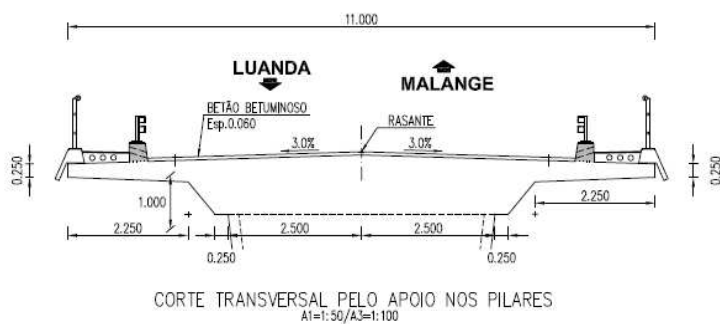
Corte Transversal Pelo Apoio Nos Pilares (Fonte: Projecto)
